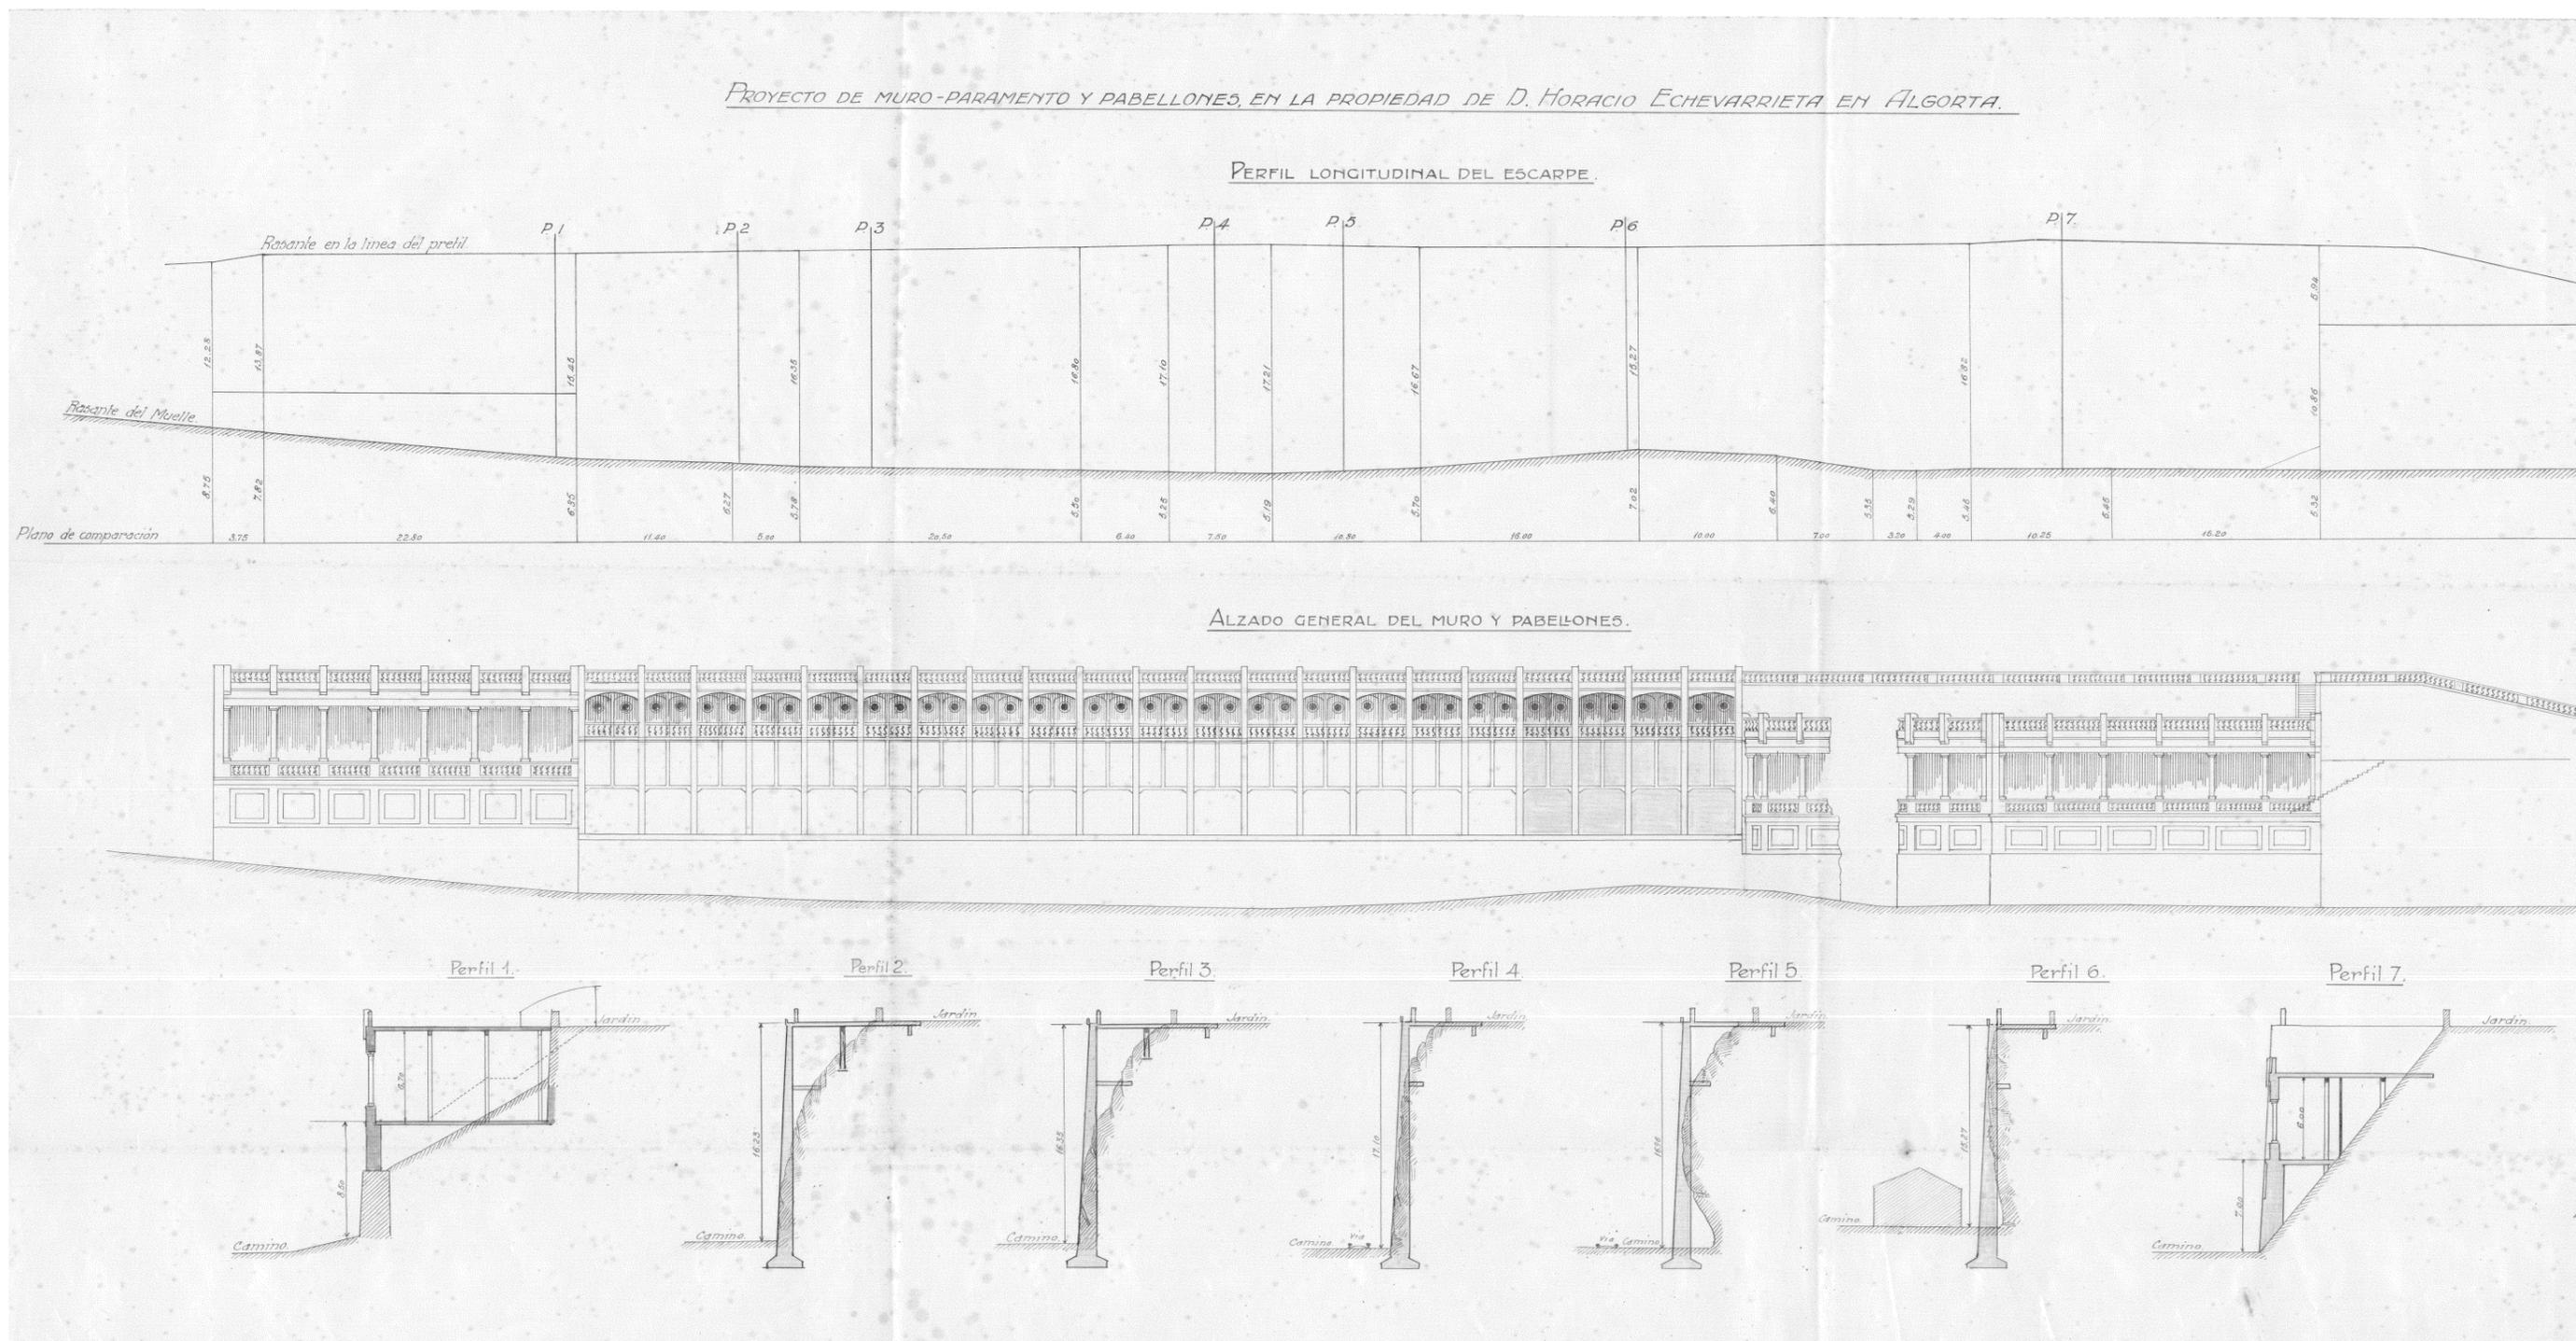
Alzados y perfiles del primer proyecto para las galerías de Punta Begoña por Ricardo Bastida, Archivo Municipal de Bilbao, Fondo Ricardo Bastida.
